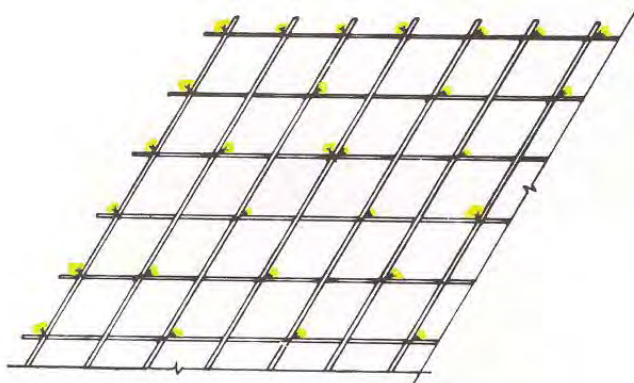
Amarres alternados en parrillas excepto en su perímetro para una adecuada rigidez
